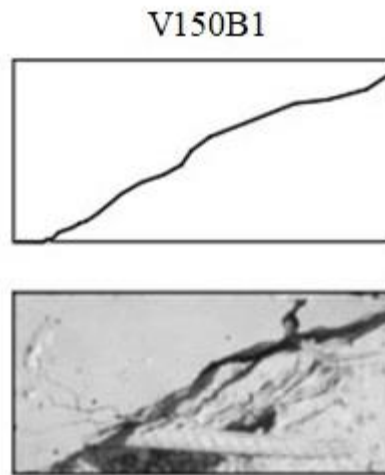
Padrão de fissuração da viga V150B1. Fonte: Autora
